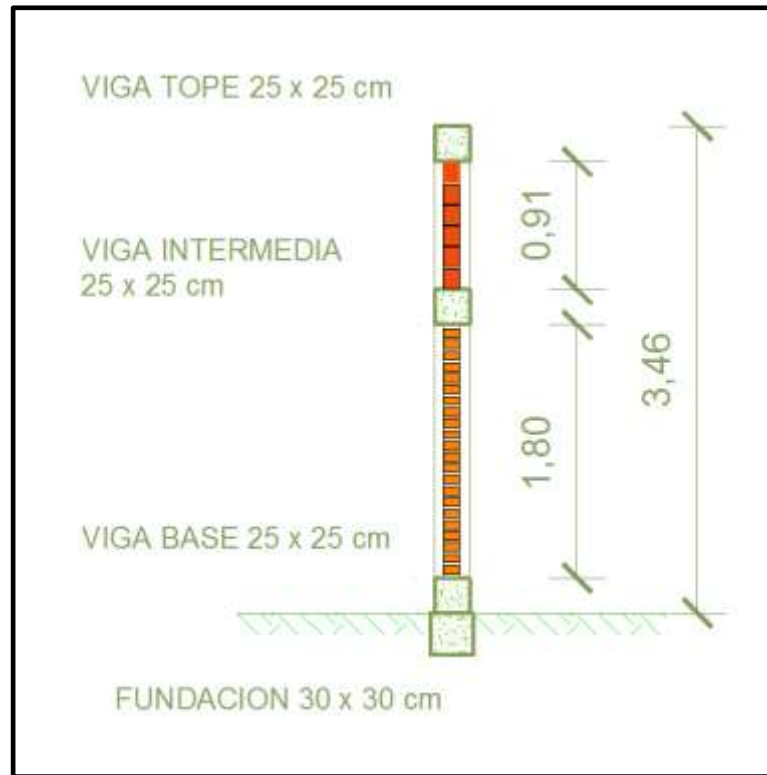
Sección transversal muro no portante perimetral propuesto
